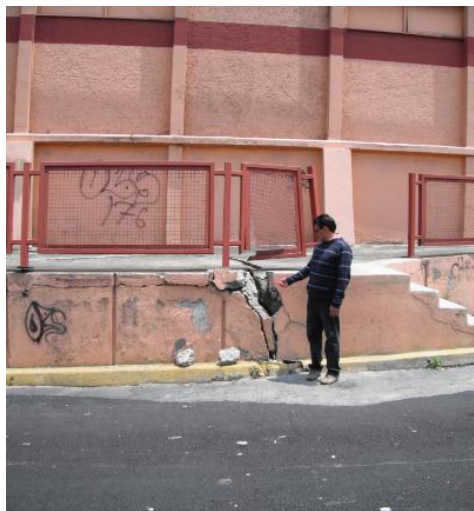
Fotografía de las fracturas en los muros de la construcción.
